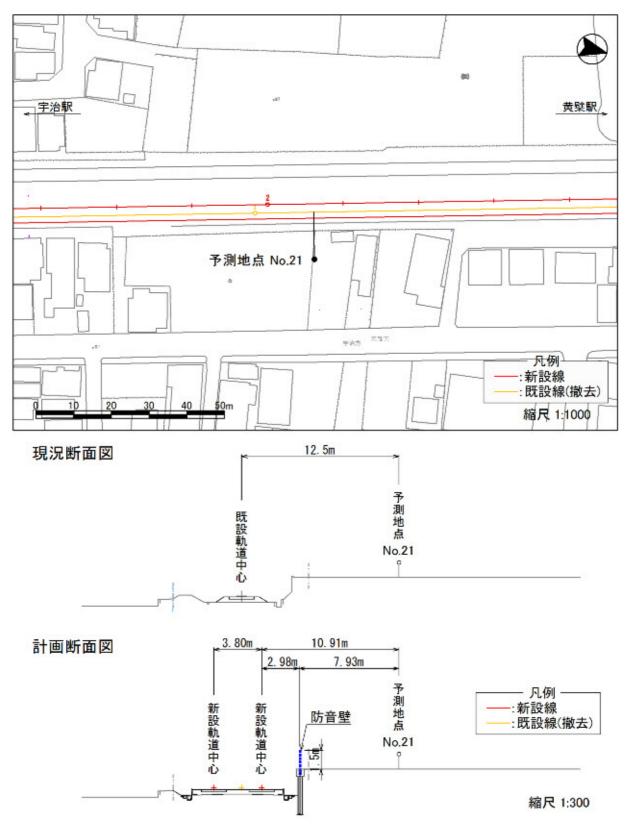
(21) 予測平面・断面図(予測地点 No. 21)
